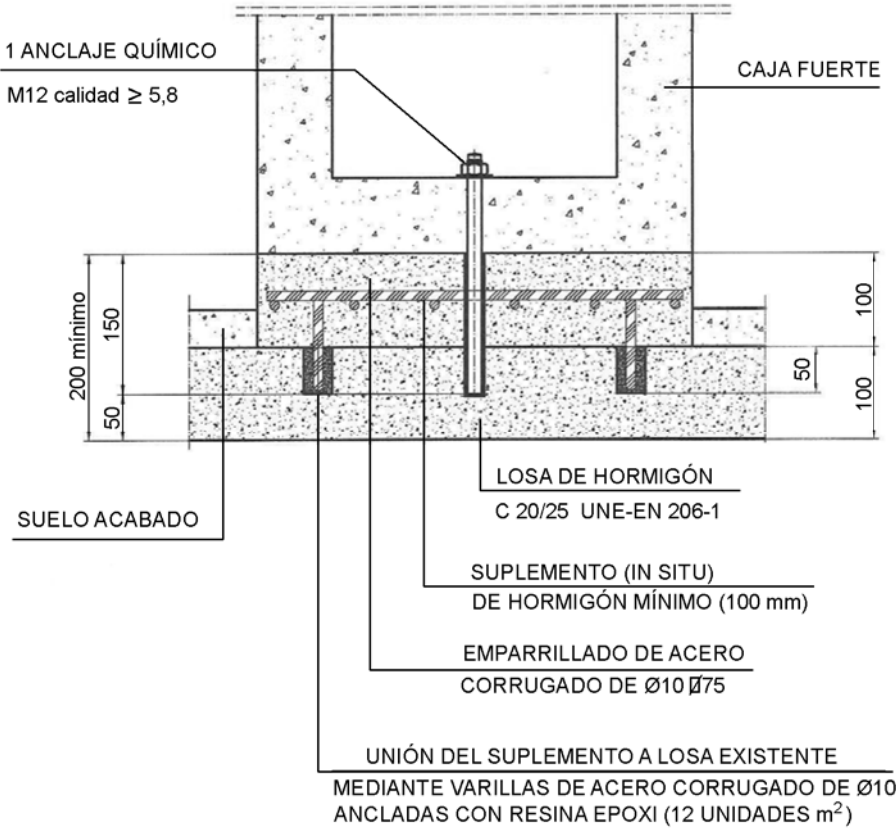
Anclaje químico en losa de hormigón suplementada
